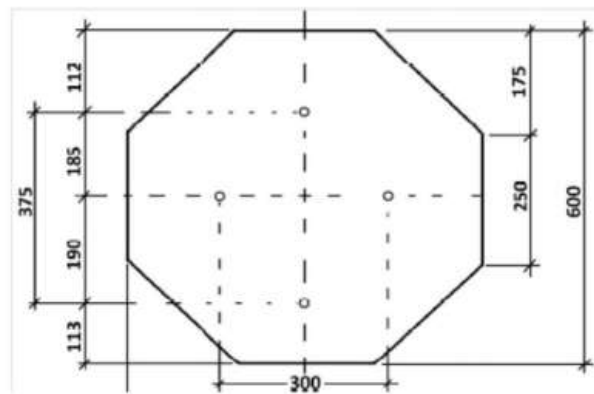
Detalhe do Dispositivo Anti-Giro e da Fundação
